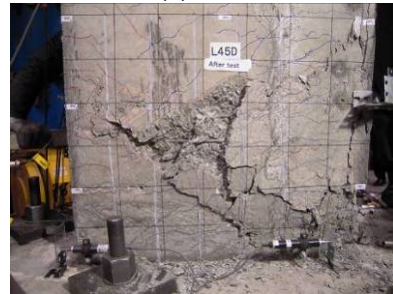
2.0%載荷サイクル終了時のひび割れ状況
